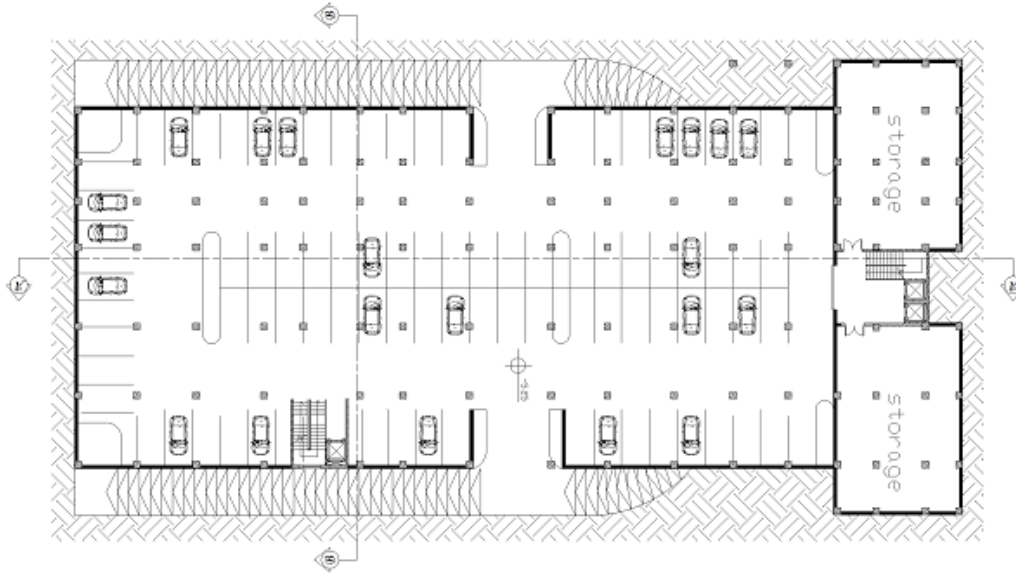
المسقط الأفقي للطابق الأرضي.
